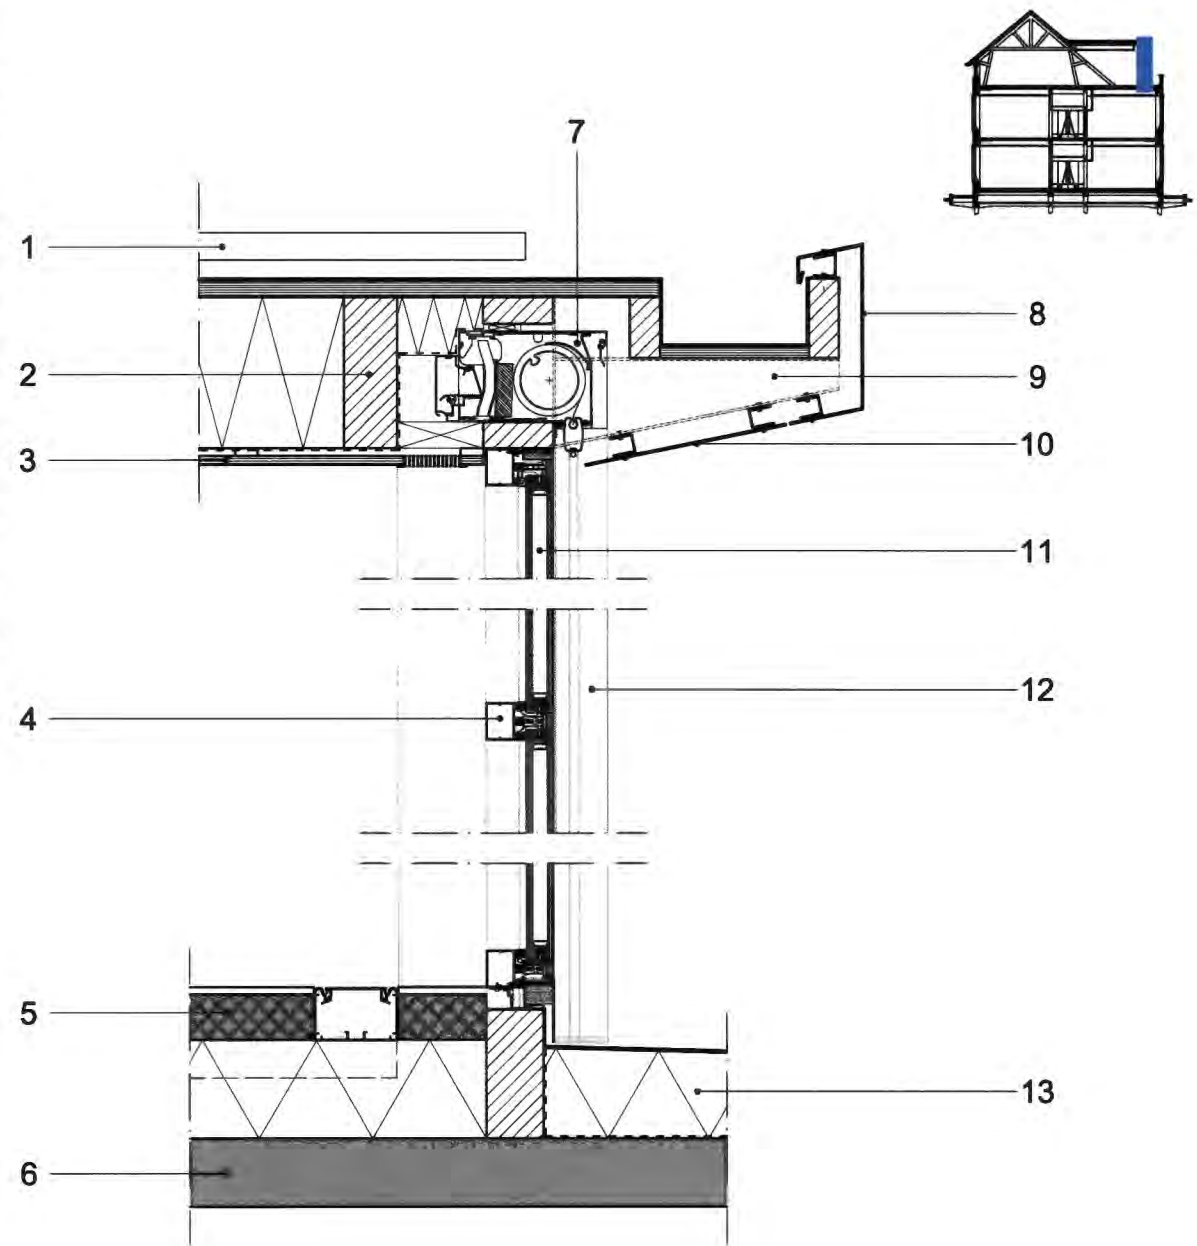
| 12 *DETAILLERING UITBOUW 2<sup>e</sup> VERDIEPING
